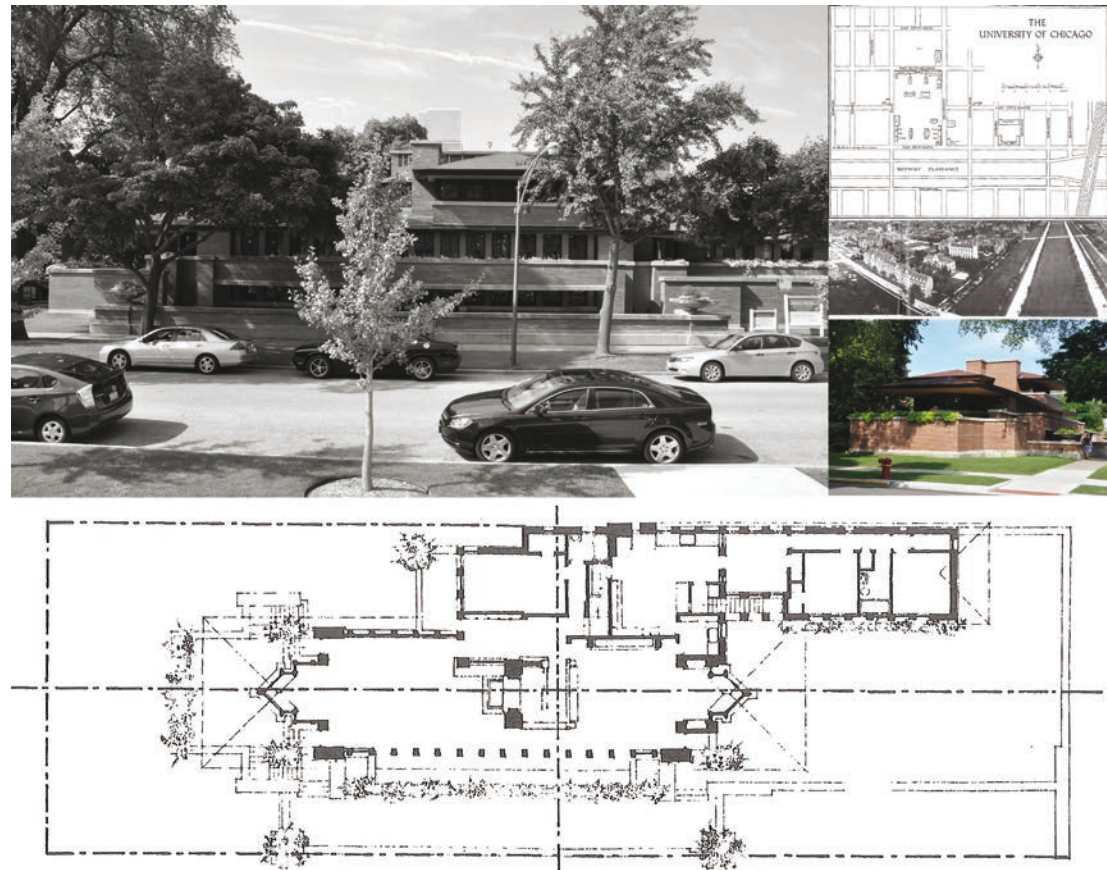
Robie House, Chicago. Planimetria del secondo livello con la proiezione delle coperture.
